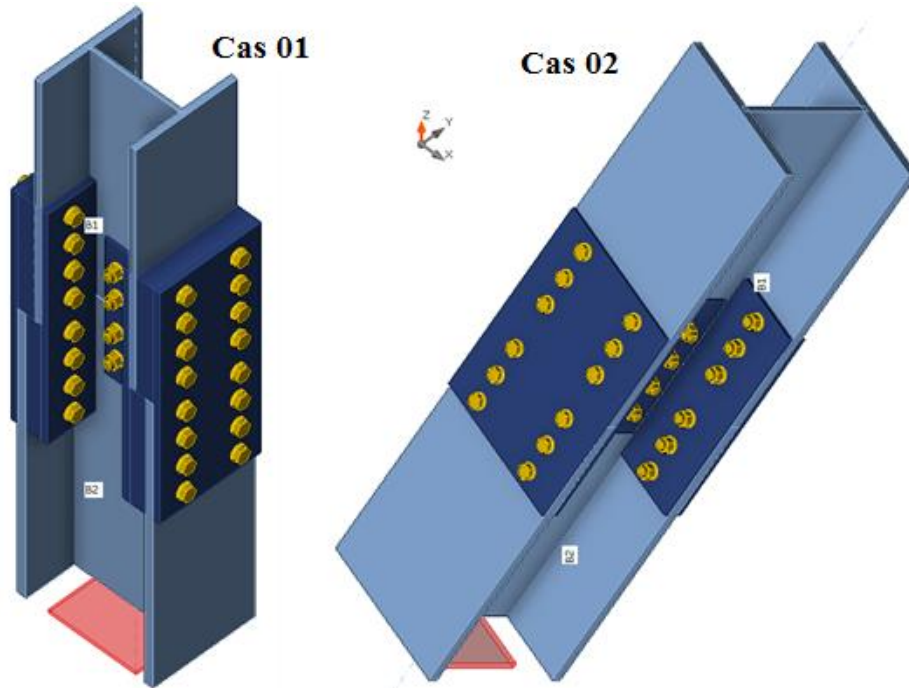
Vue 3D de l'assemblage poteau poteau.
